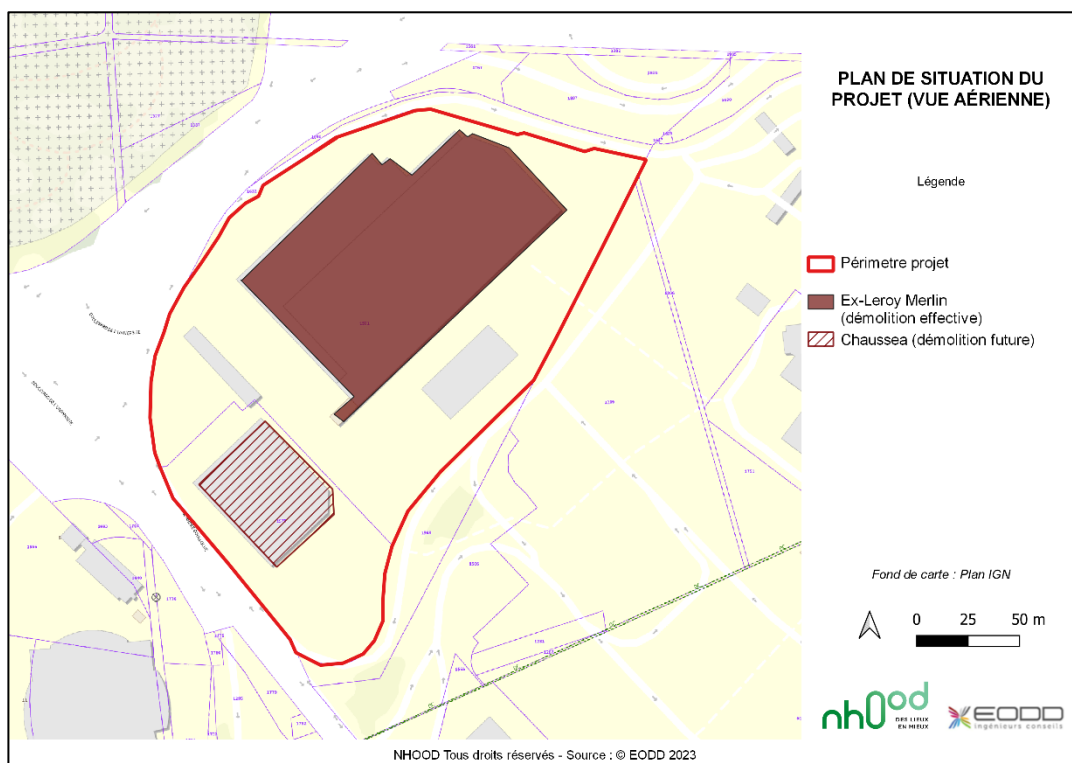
Plan IGN rapproché et localisation de la zone d'implantation
